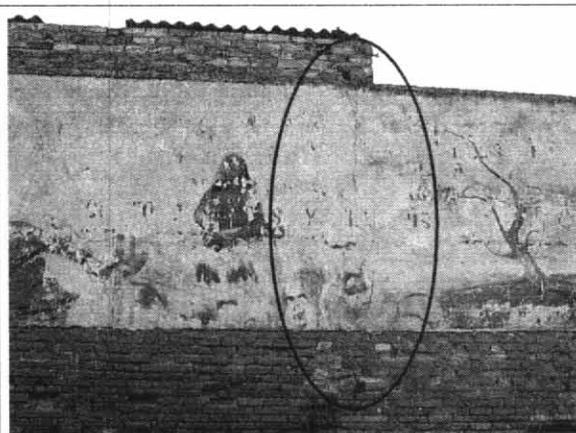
Agrietamiento vertical en la cara externa del muro culata.
